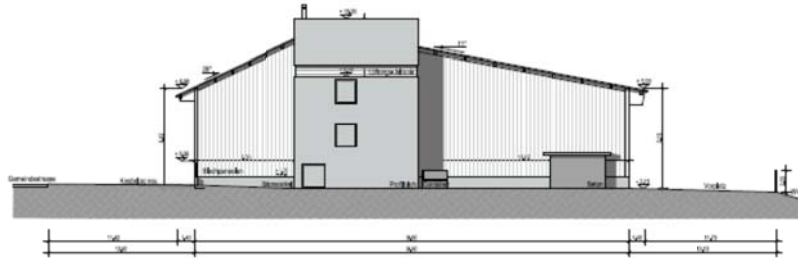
geplanter Bau, Fassade West mit Holzvergasungsanlage
